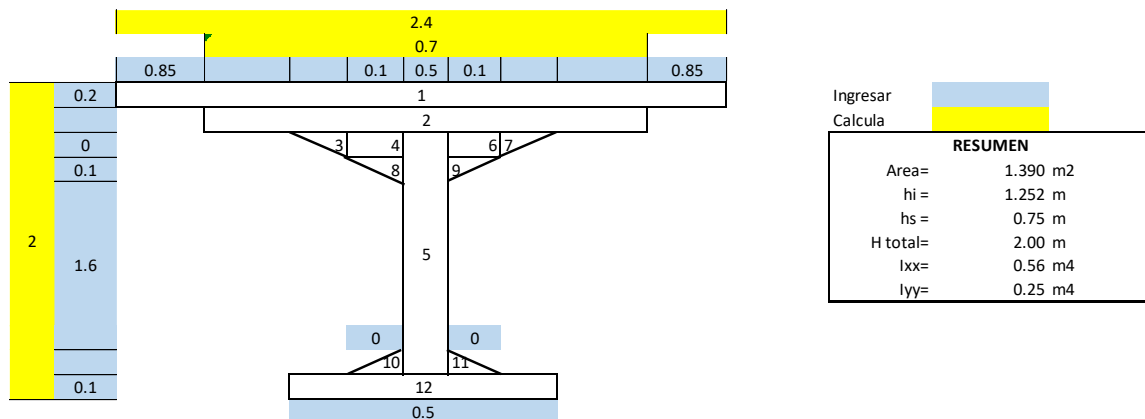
Propiedad Geométricas de la Viga h=2.0 m
